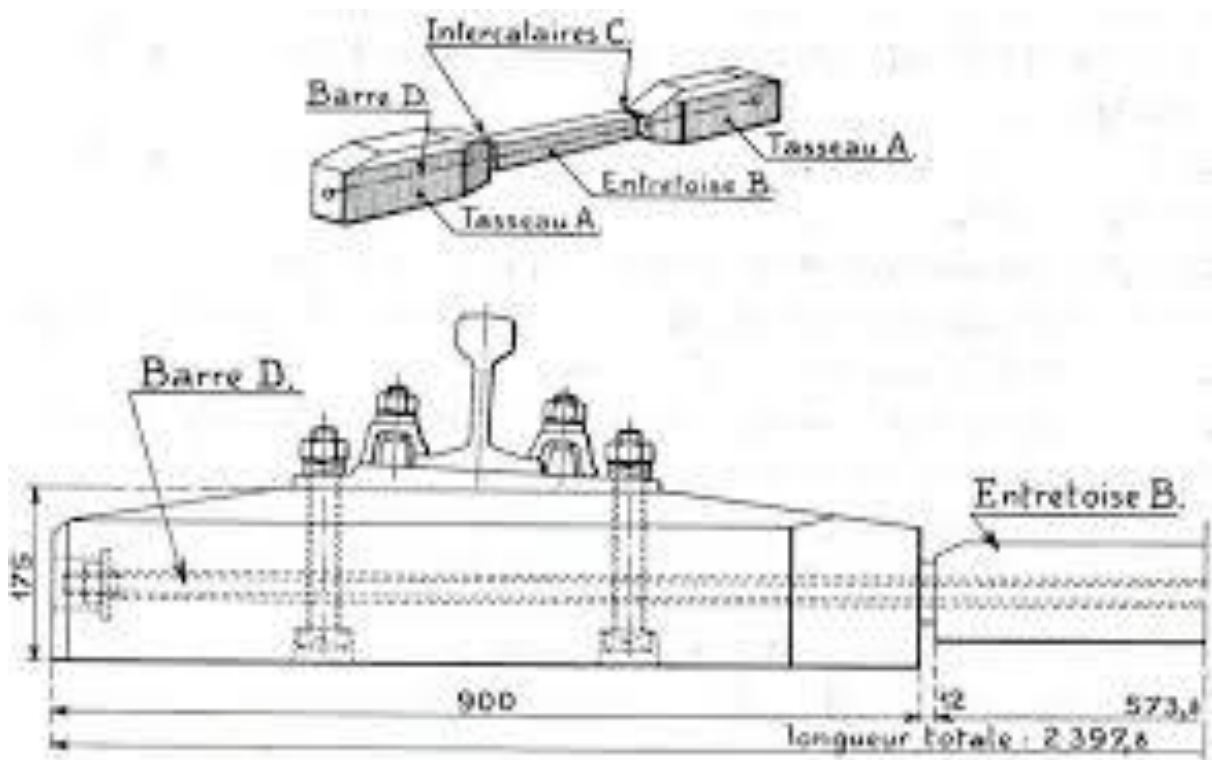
Schéma Technique Détaillé De L'assemblage D'une Traverse Bi-Bloc Avec Entretoise Et Barre De Liaison
